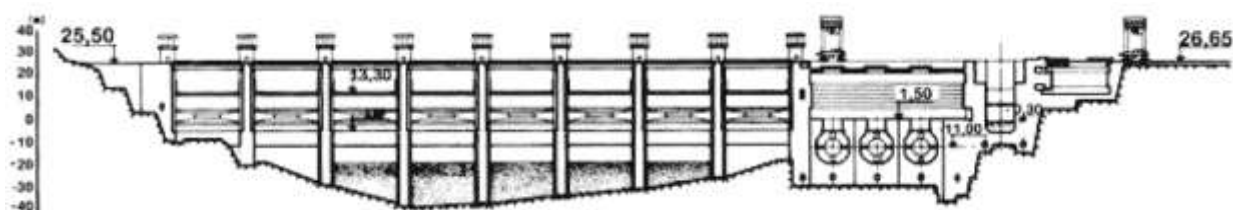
Perfil longitudinal da barragem de Crestuma-Lever [5].
